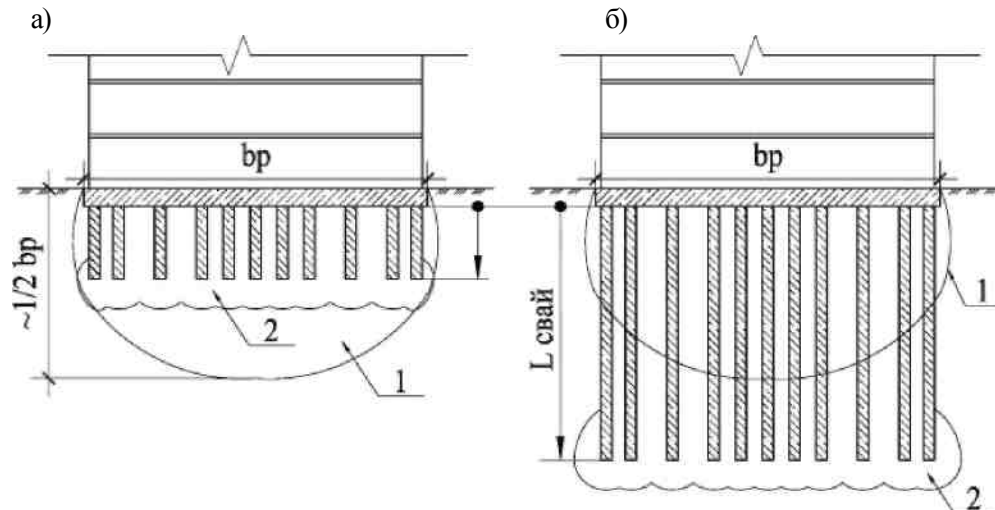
Взаємодія фундаментних конструкцій з ґрунтовим масивом:
